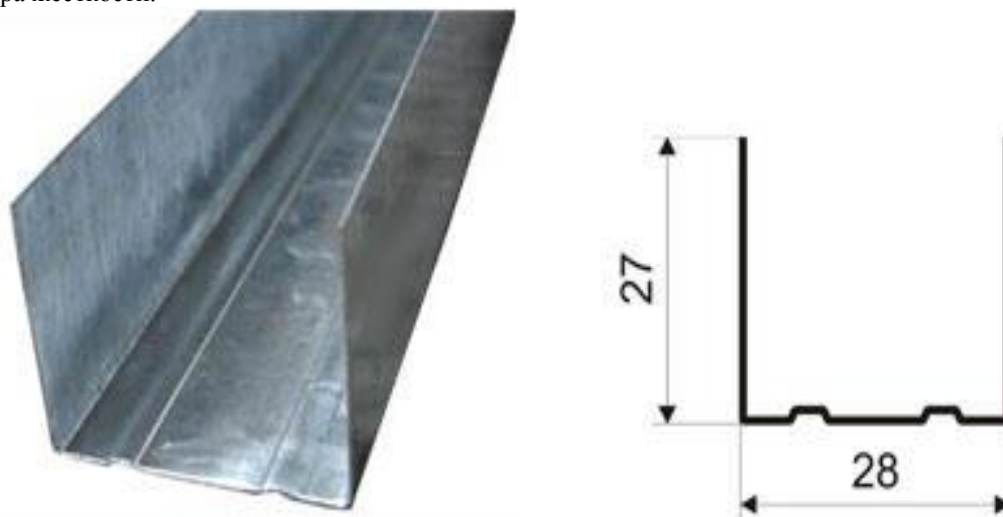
Профиль потолочный направляющий 28*27мм
